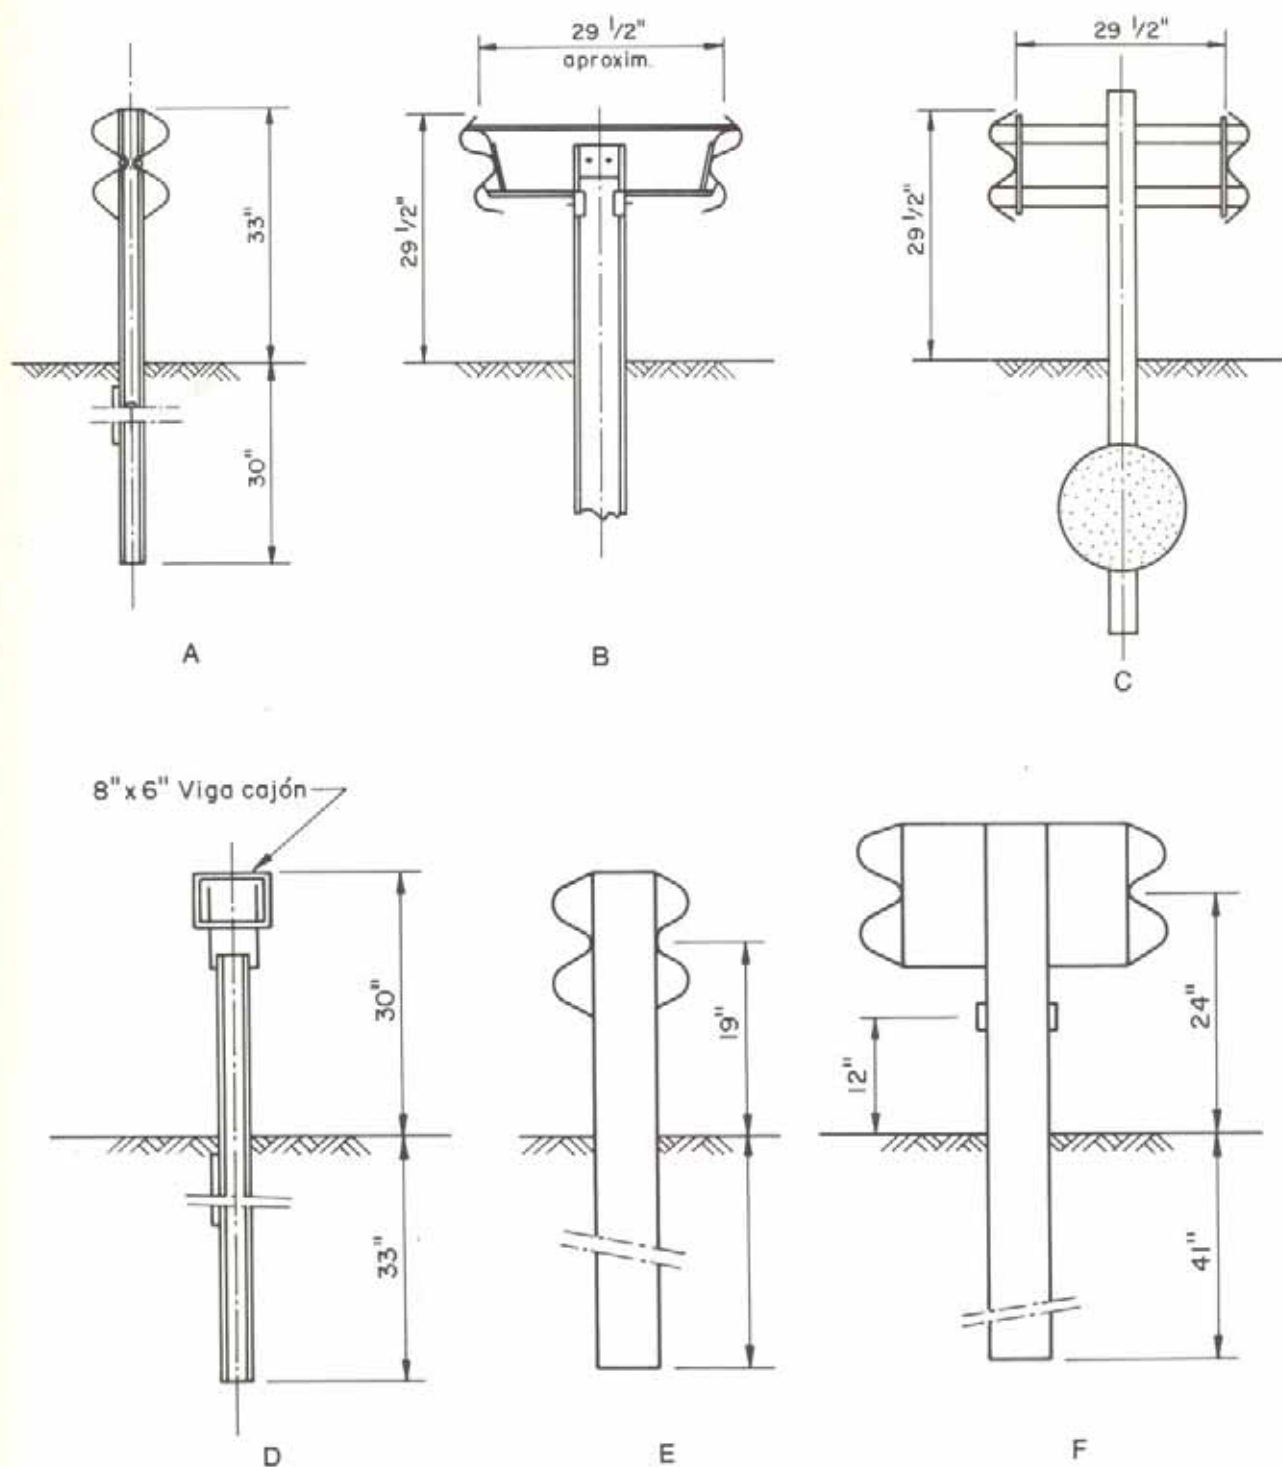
Diversos tipos de barreras semi-rígidas. a. Viga W sobre poste débil. b. Barrera Baden Wurtemberg. c. Barrera tipo holandés. d. Barrera con viga de cajón. e. Barrera con viga W doble sobre poste fuerte. f. Barrera con viga W doble saliente.
